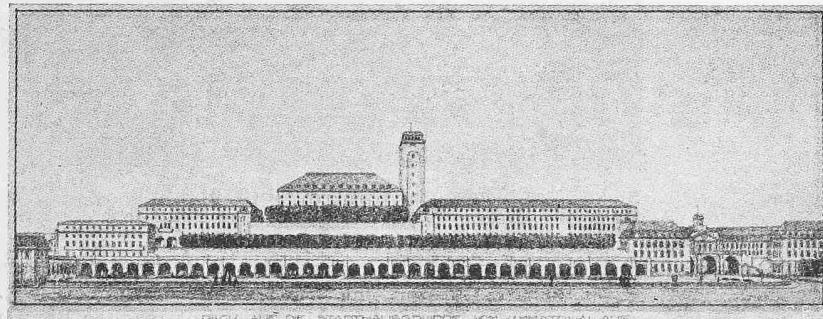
Projekt für ein Stadthaus auf dem Lindenholz
